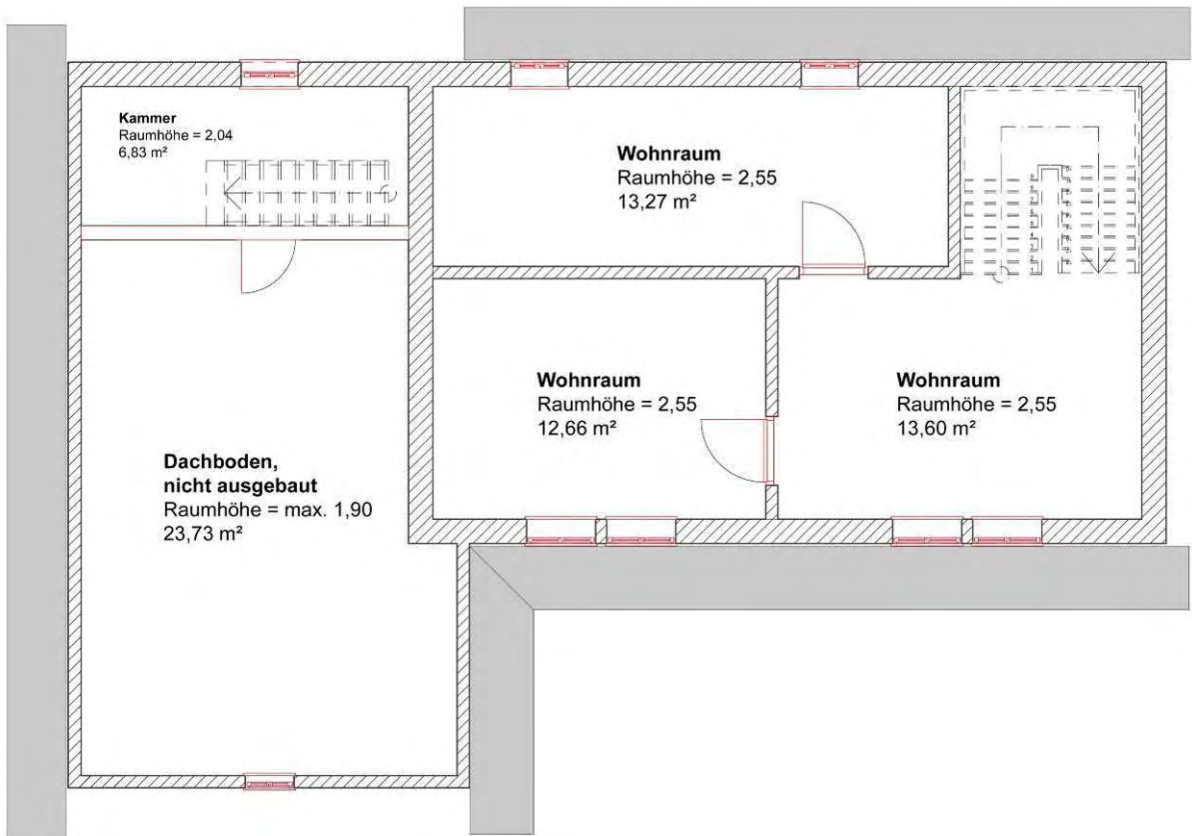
Grundriss Obergeschoß (Bestand)
